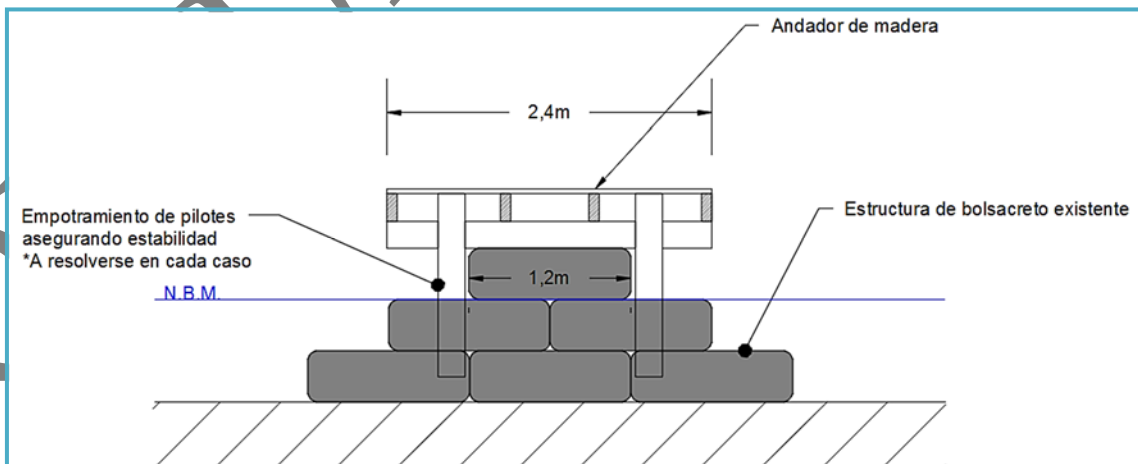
Detalle típico de andadores de madera sobre espigones
